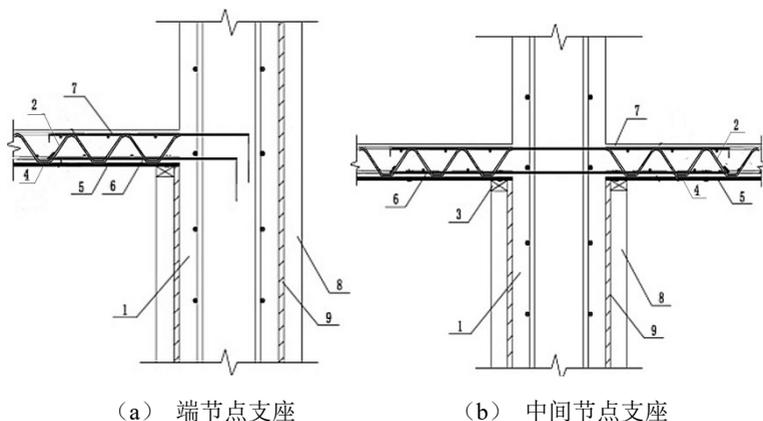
桁架楼承板与预制混凝土剪力墙支座连接构造示意（二）
